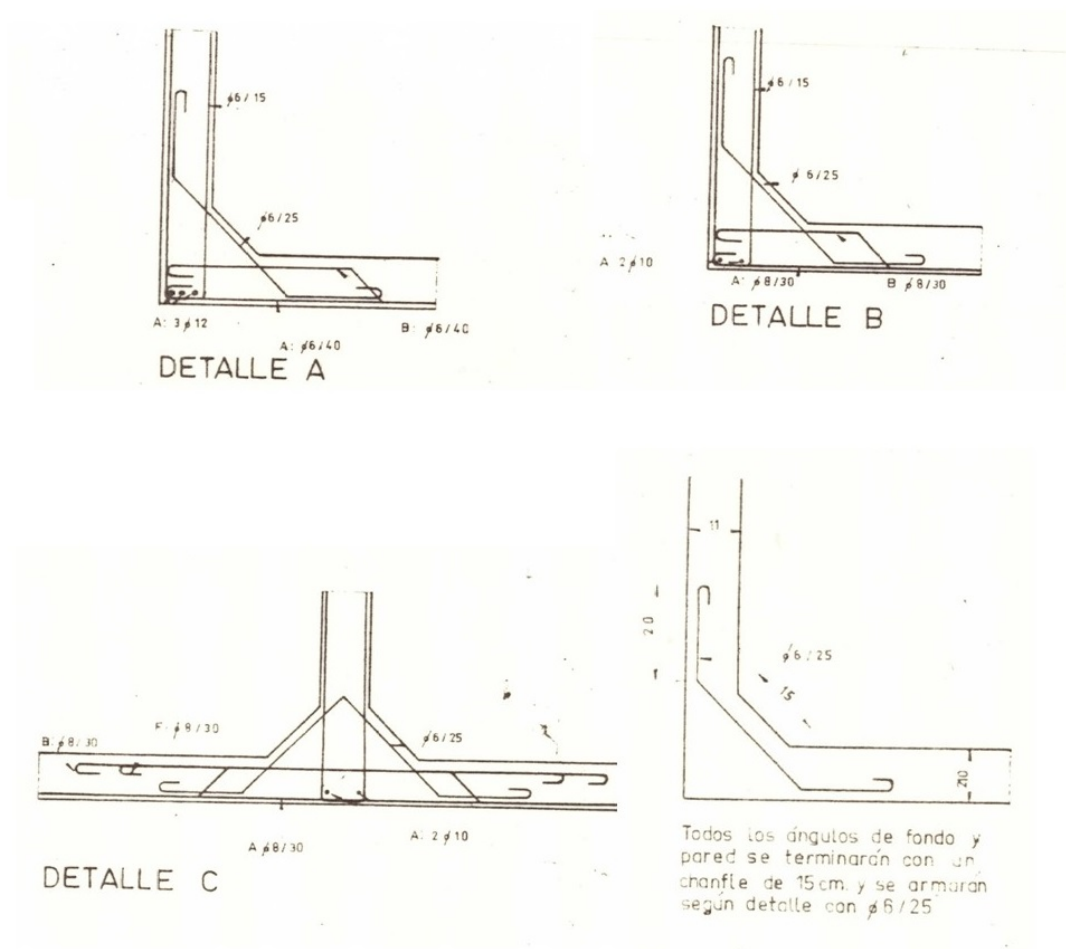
Detalle de armado de chanfle de tanque. (Fuente: Planos de estructura)
